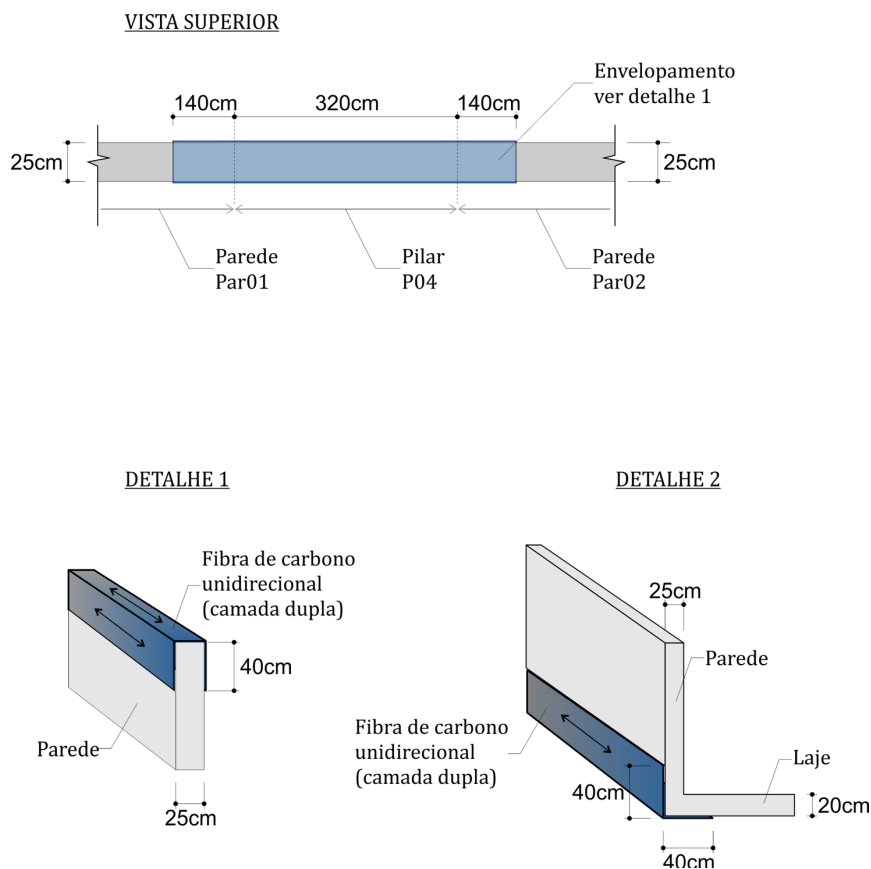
Croqui com corte e vista superior do reforço da PAR01 e pilar P4 com fibra de carbono.
